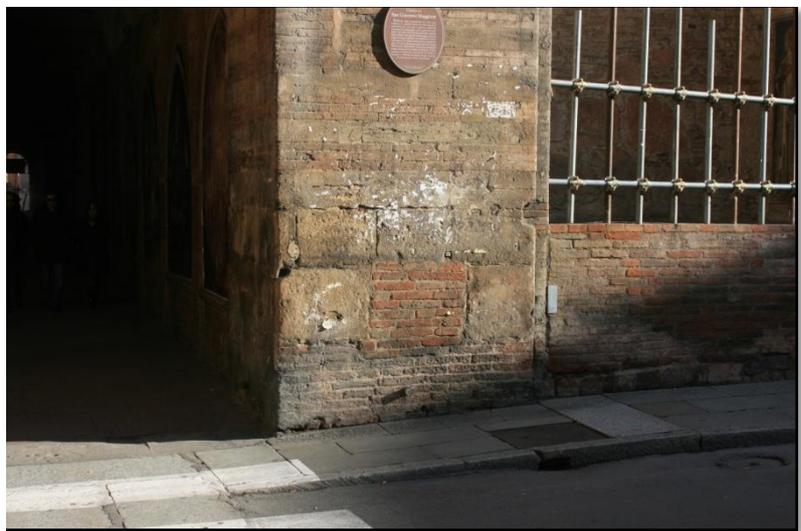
Muratura del pilastro sinistro al di sotto del portico bentivolesco
